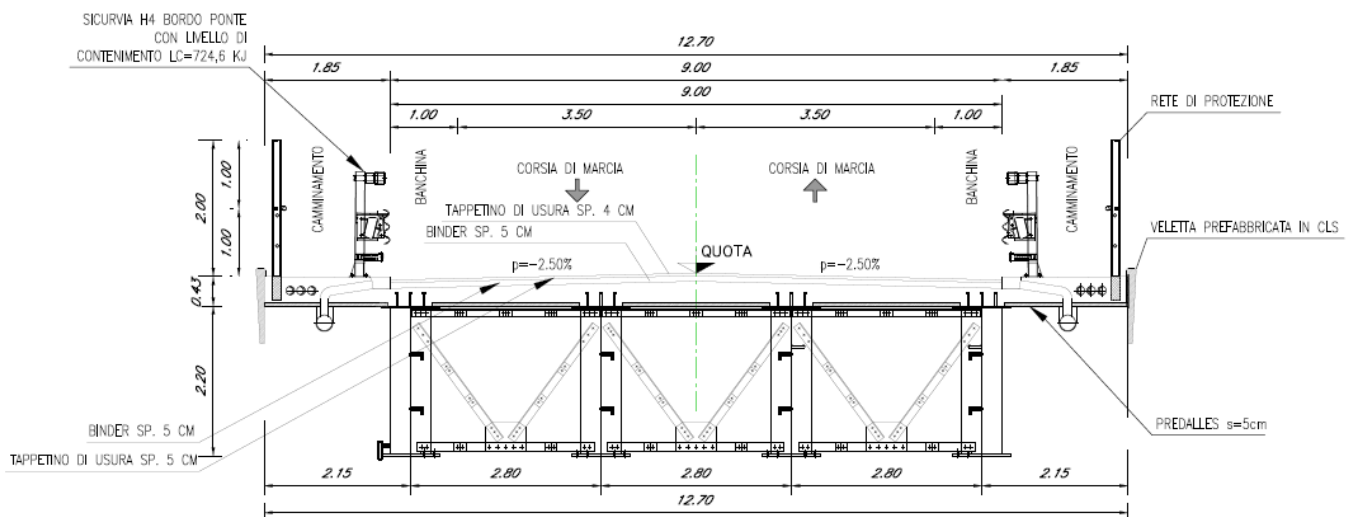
Sezione trasversale tipo dell'impalcato: sezione corrente
